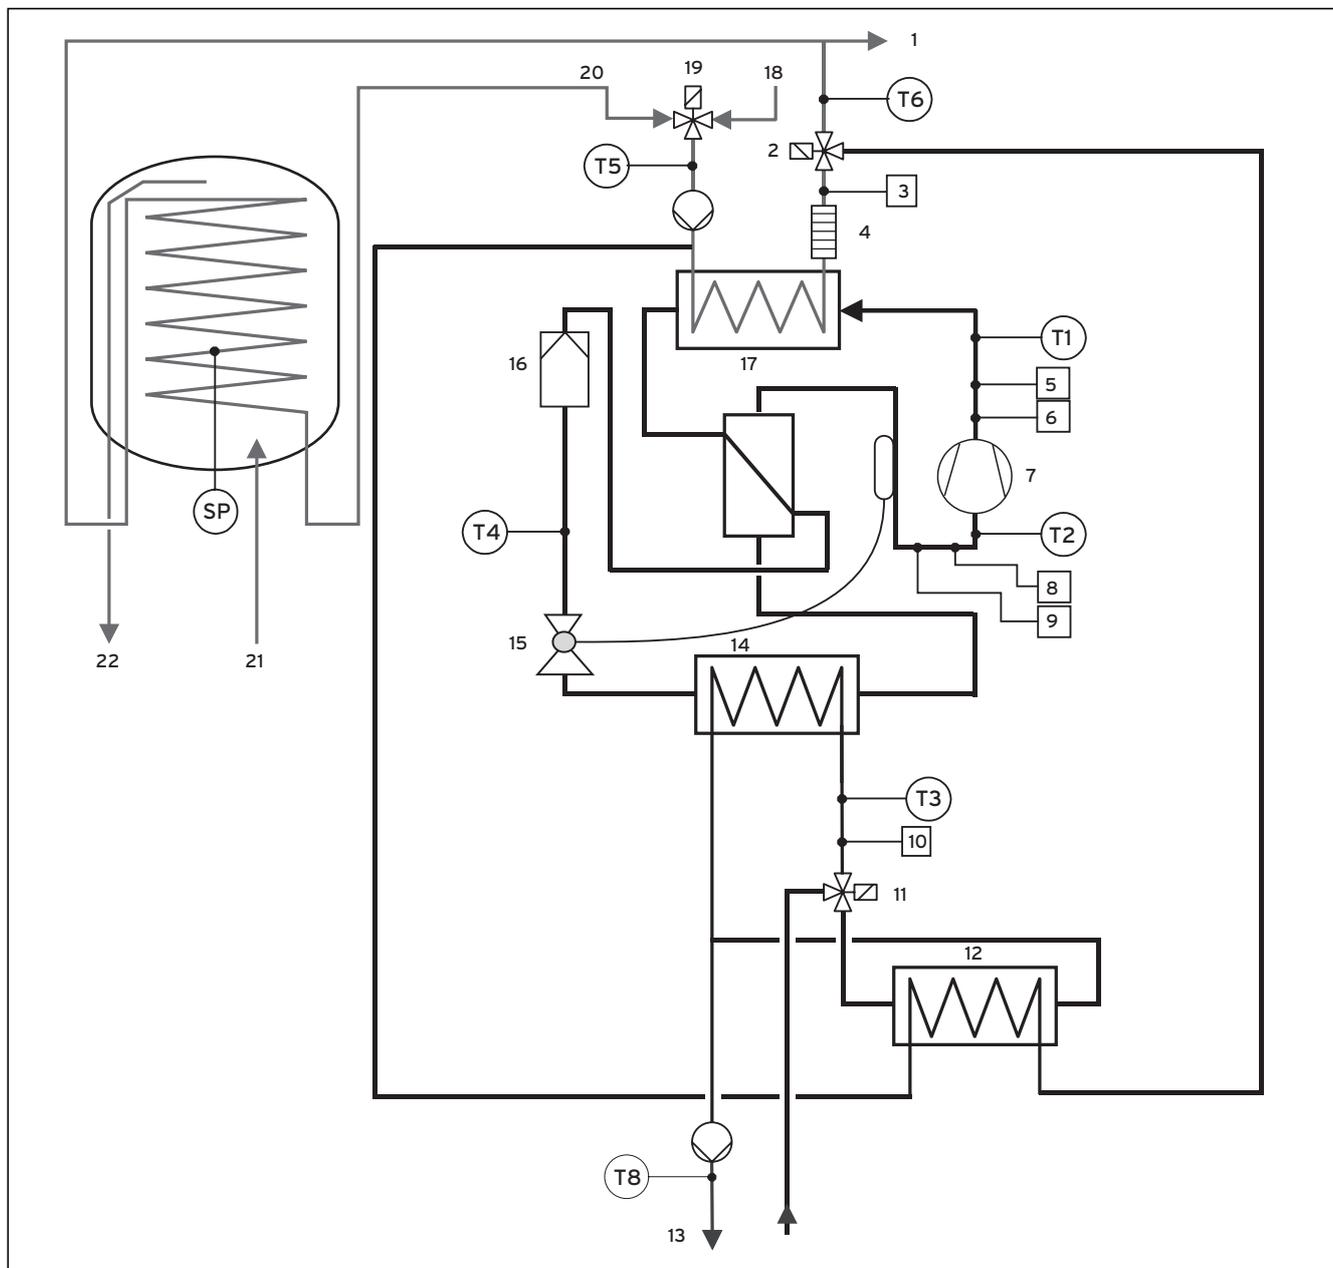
, Anhang, Wärmepumpenschema VWS mit integriertem Warmwasserspeicher
